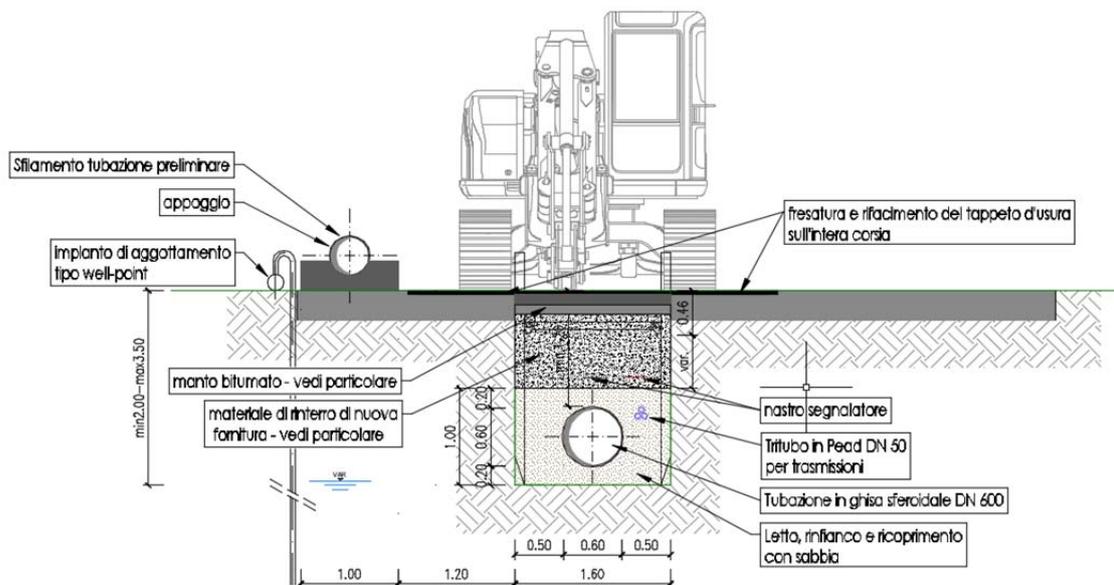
Sezione tipo di posa della condotta in progetto DN600
